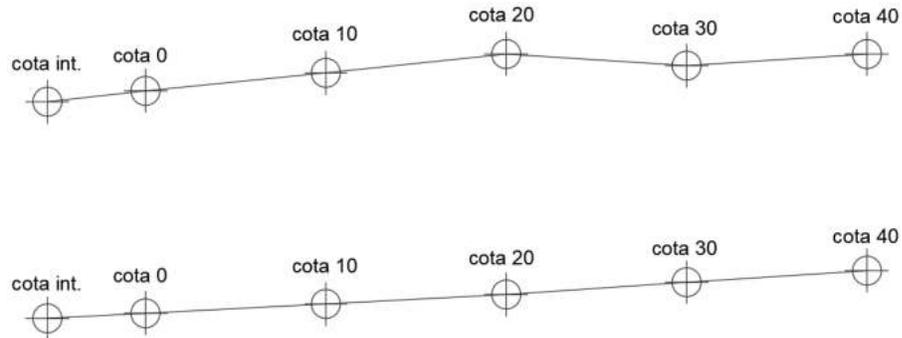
Secciones transversales calle secundaria punto 6 levantamiento topográfico
